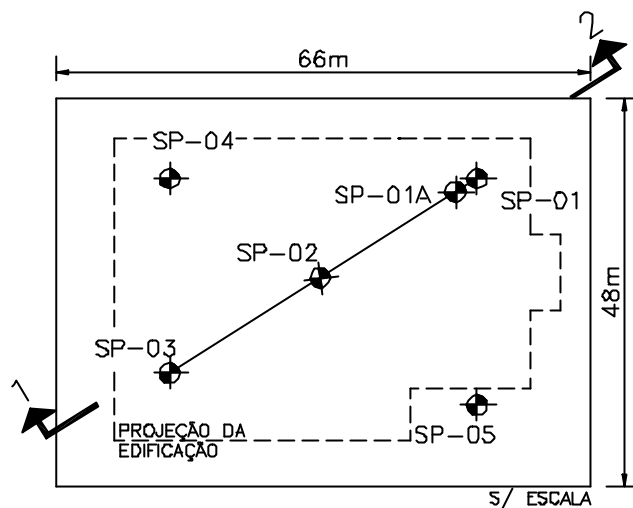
Croqui de Localização das Sondagens à Percussão.
